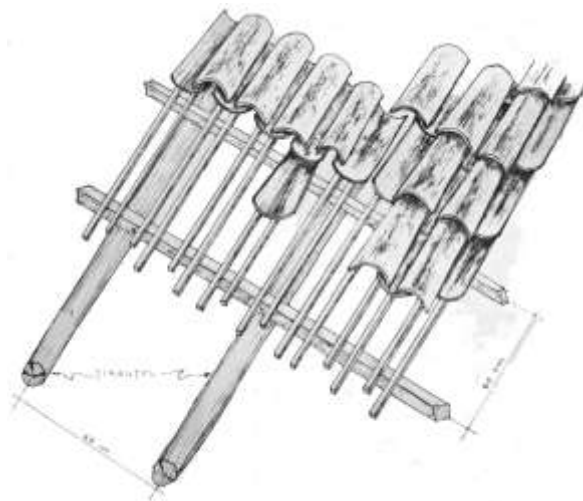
Detalle constructivo cubierta de teja sobre tirilla de madera.
